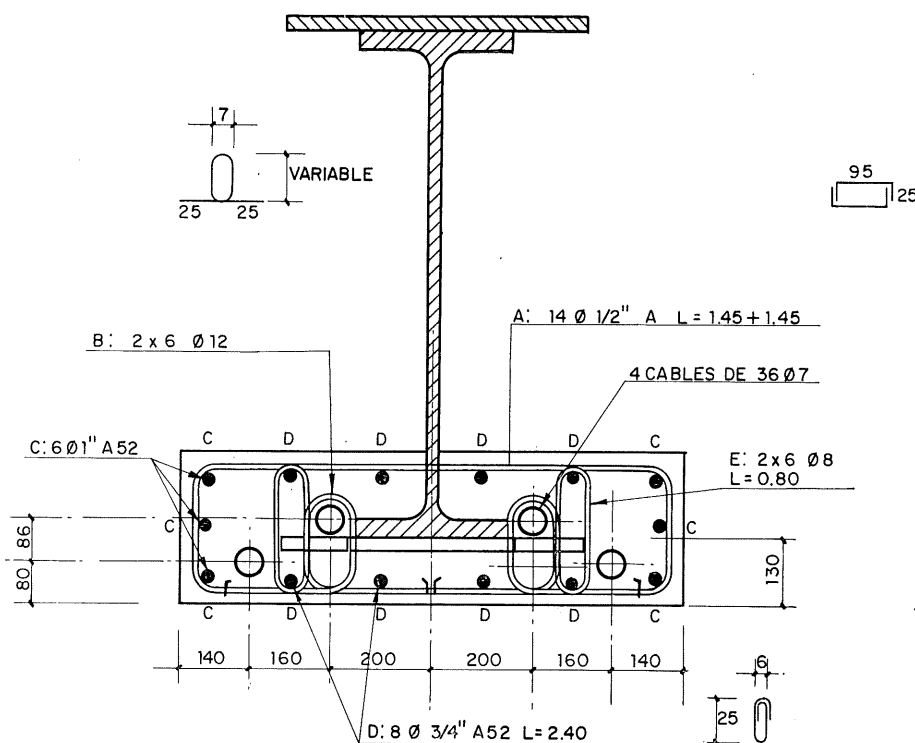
Sección transversal de una viga (a 1 m del apoyo).
